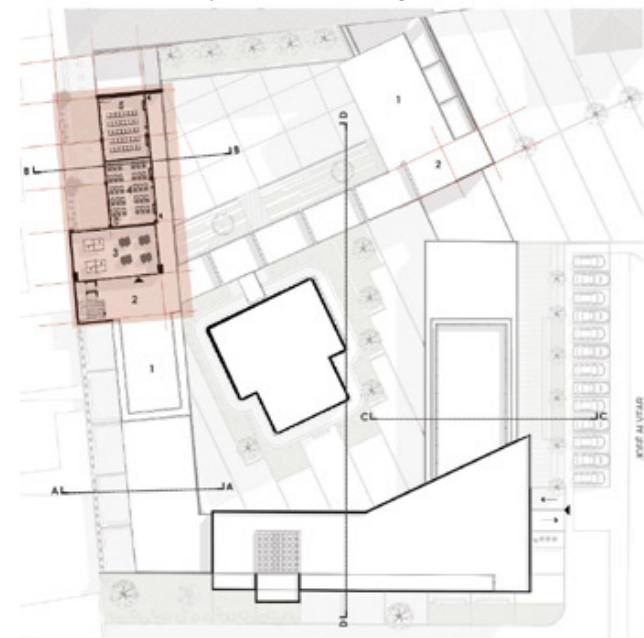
Esquema 1ra Planta alta | Fuente: Elaboración propia
